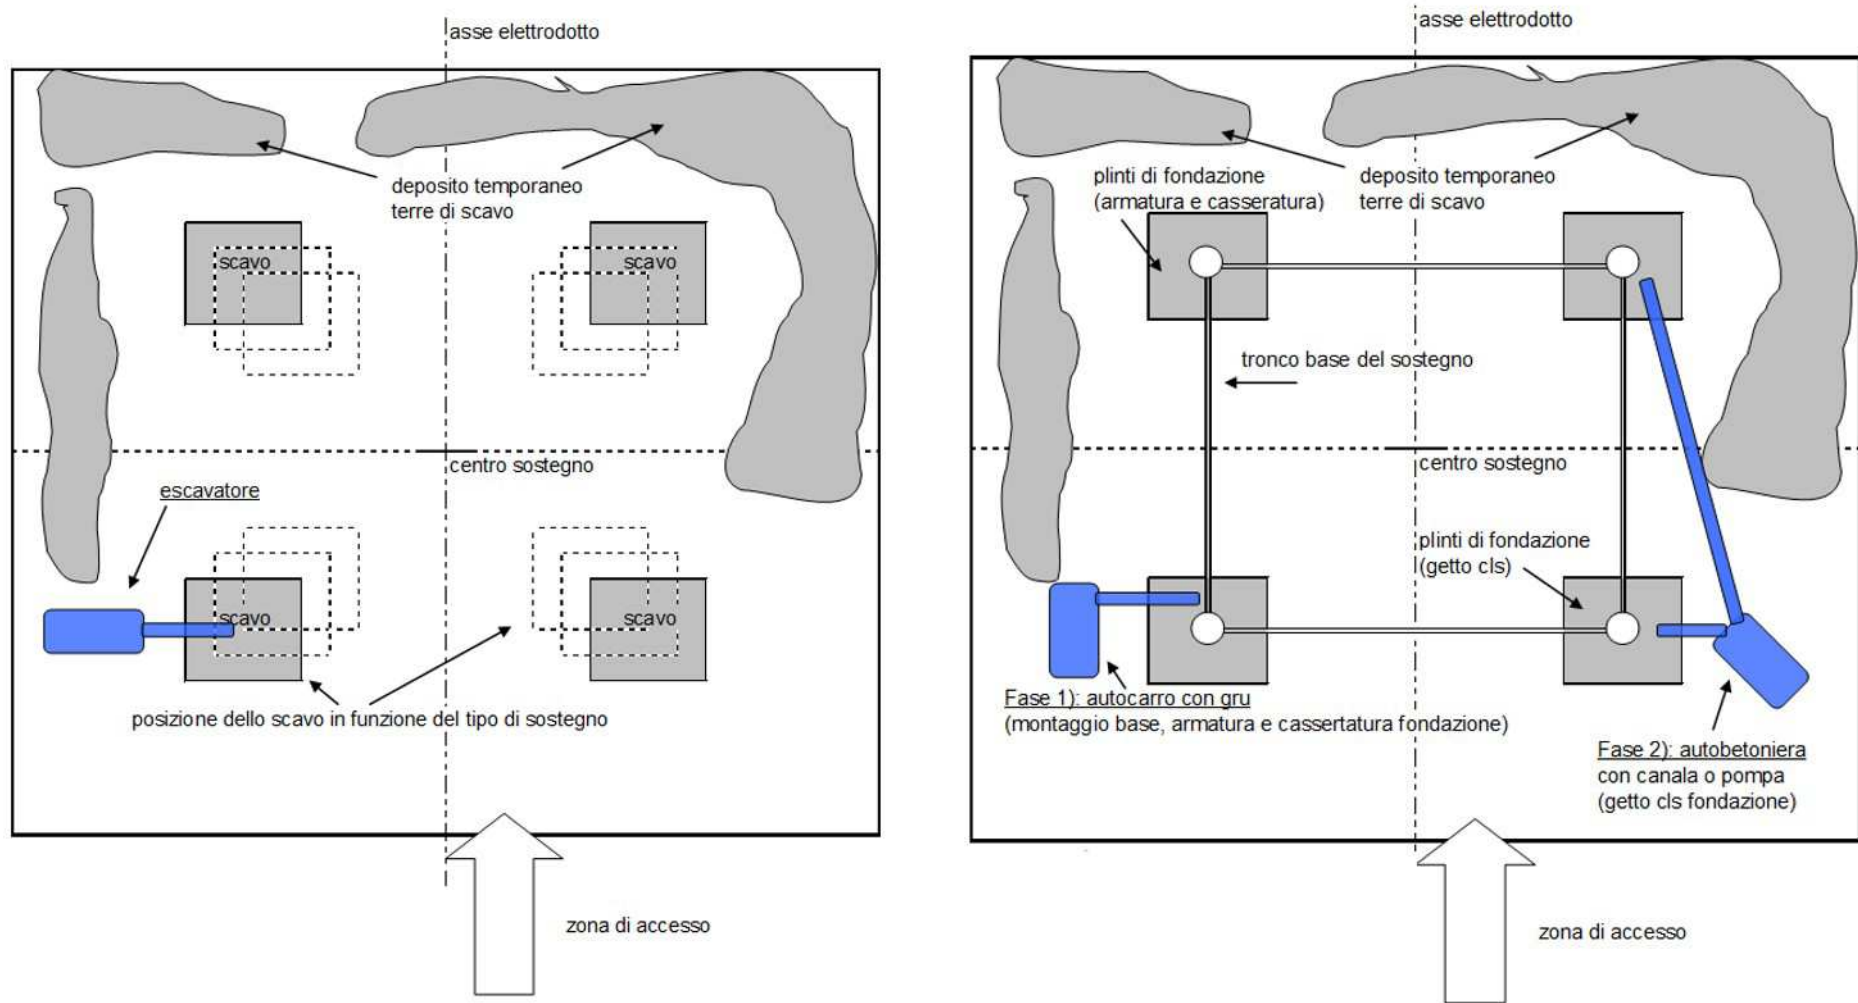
Planimetria dell'Area Sostegno (scavo di fondazione - getto e basi) - Tipologico
